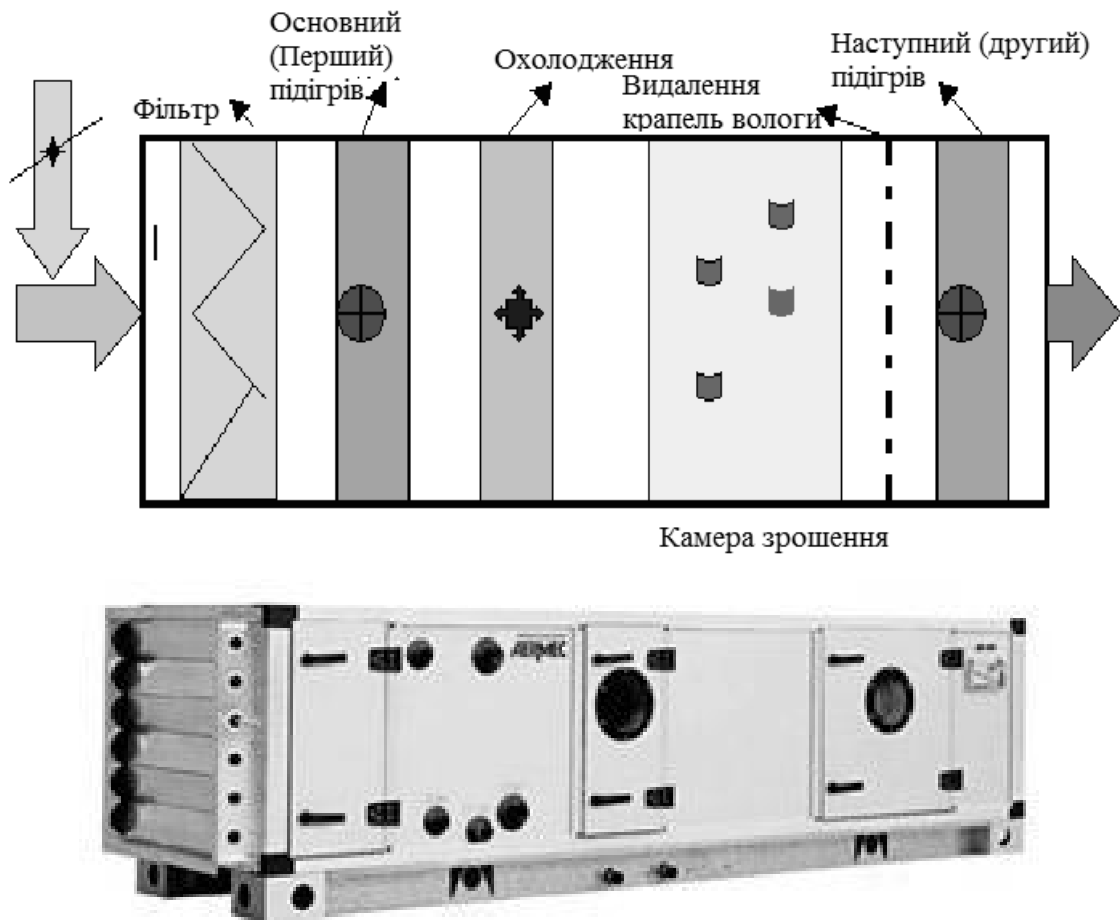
Принципова схема й типовий зовнішній вигляд центрального кондиціонера або приточної установки
